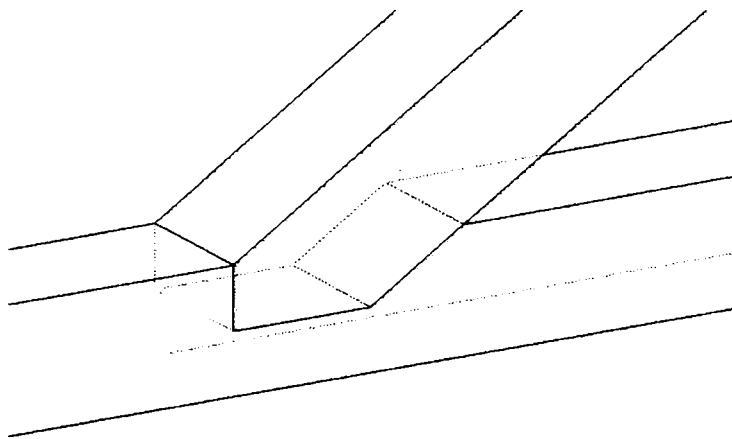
Eclisare frontală cu tăierea frontală potrivită
